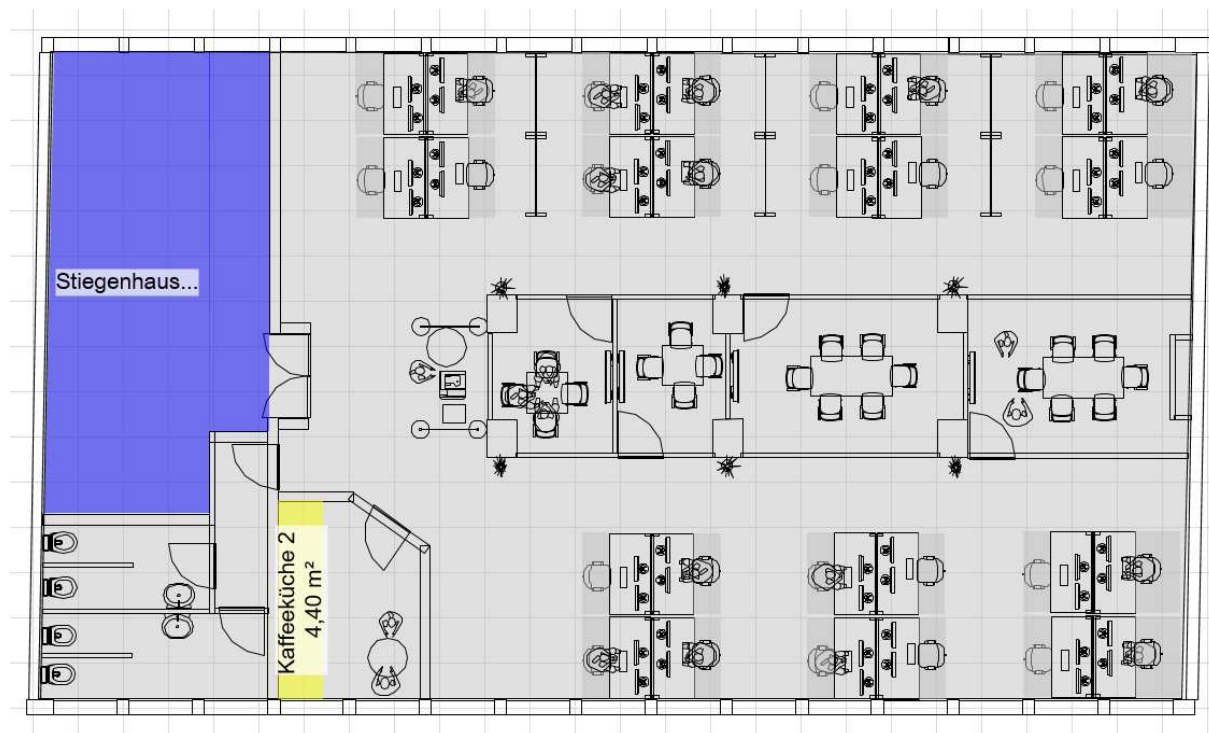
Grundriss Use Case Bürogebäude
